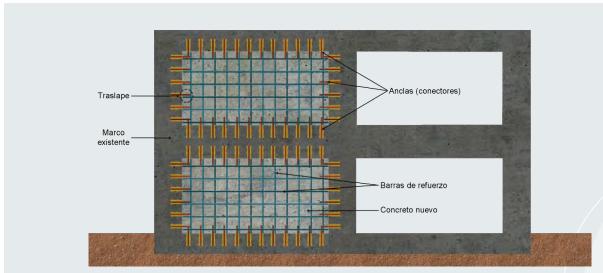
Anclas para unir elementos de concreto. Fuente: elaboración propia con base en Terán (2009).
